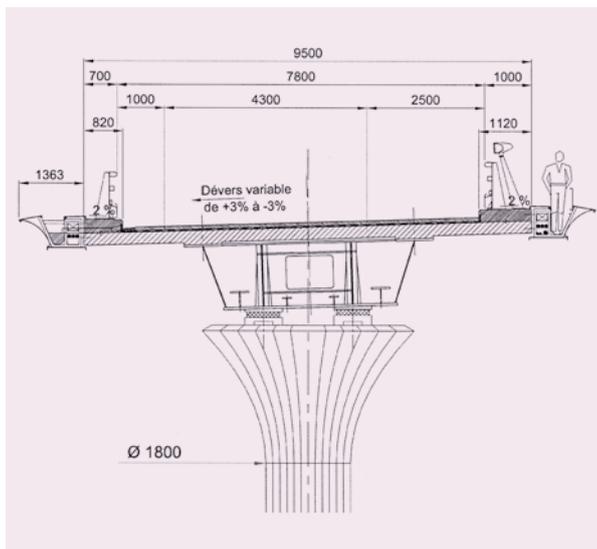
coupe transversale sur pile et superstructures de l'OA-SD
